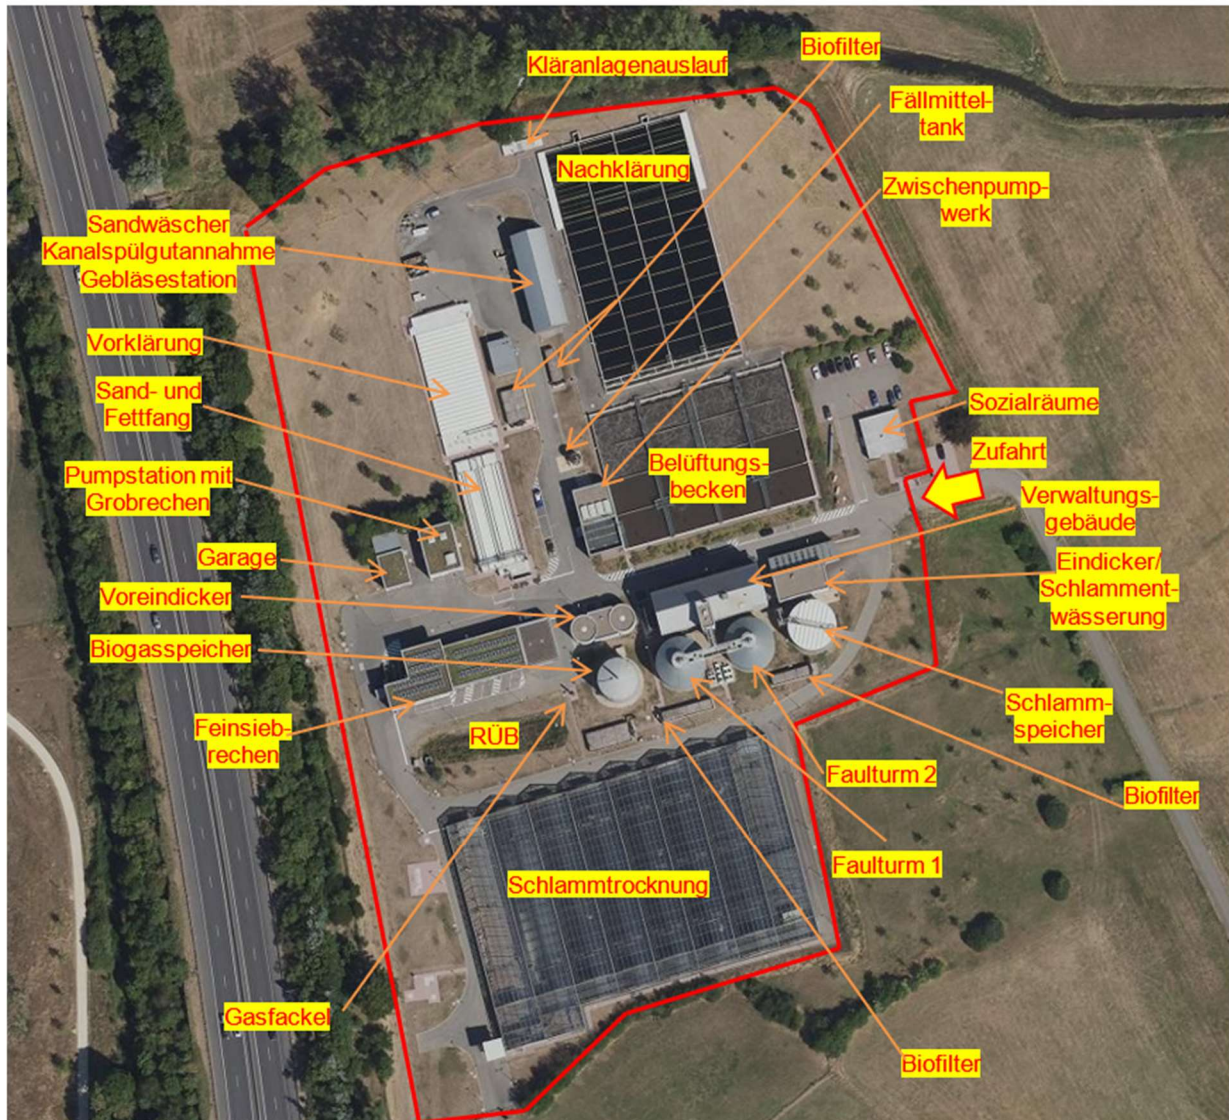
Lageplan der bestehenden Kläranlage Bettembourg
